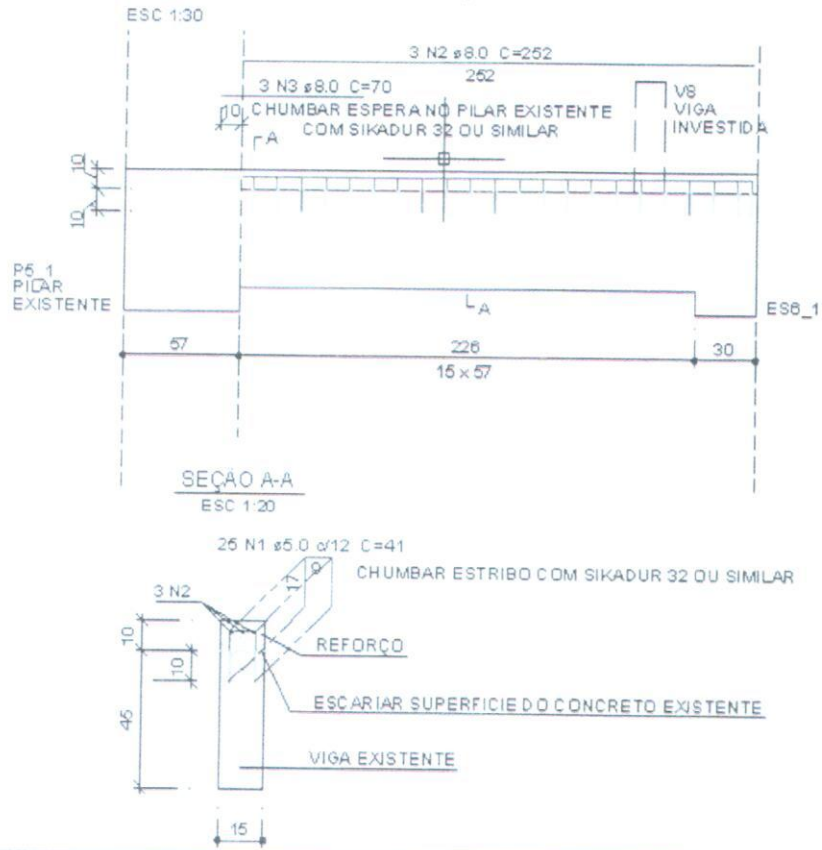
DETALHE DE REFORÇO DA VIGA VBA\_13
